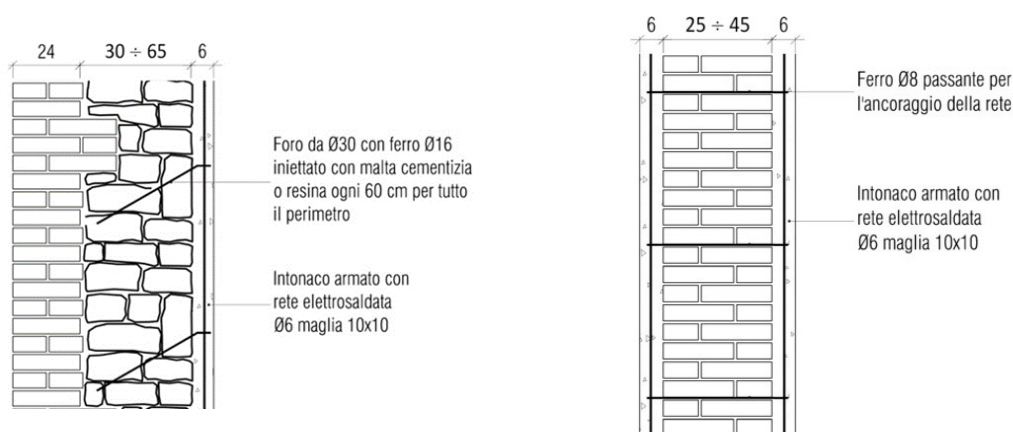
Tipologie murarie MUR3 e MUR2
